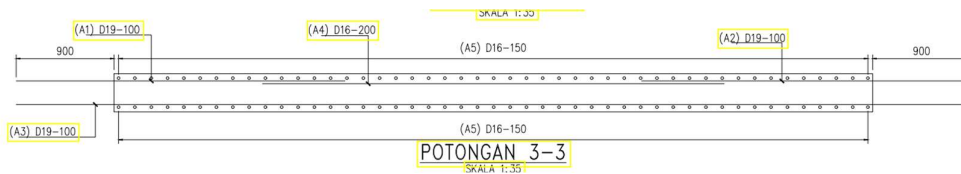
Detail Potongan 2 Half Slab Tebal 25 Cm
